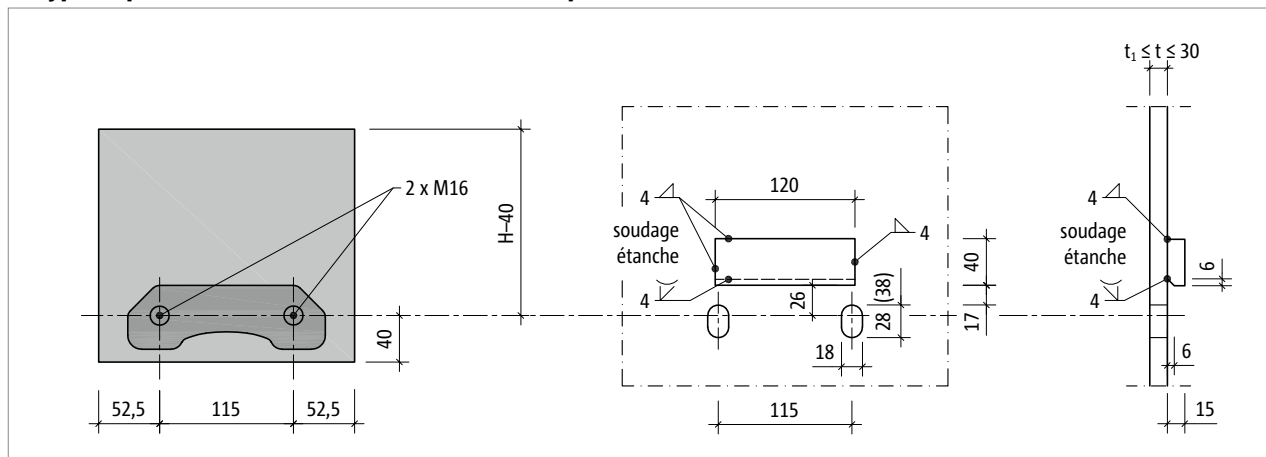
Schöck Isokorb® XT type SQ : construction de la platine frontale de raccordement
